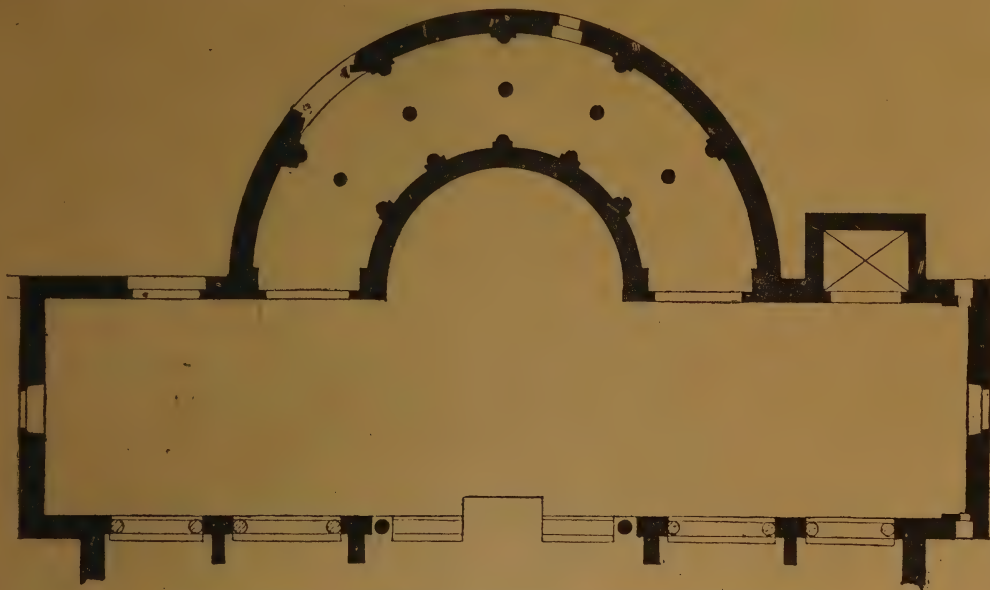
Plan de Saint-Jean de Latran. — (Echelle de 0.004 p. m.)
